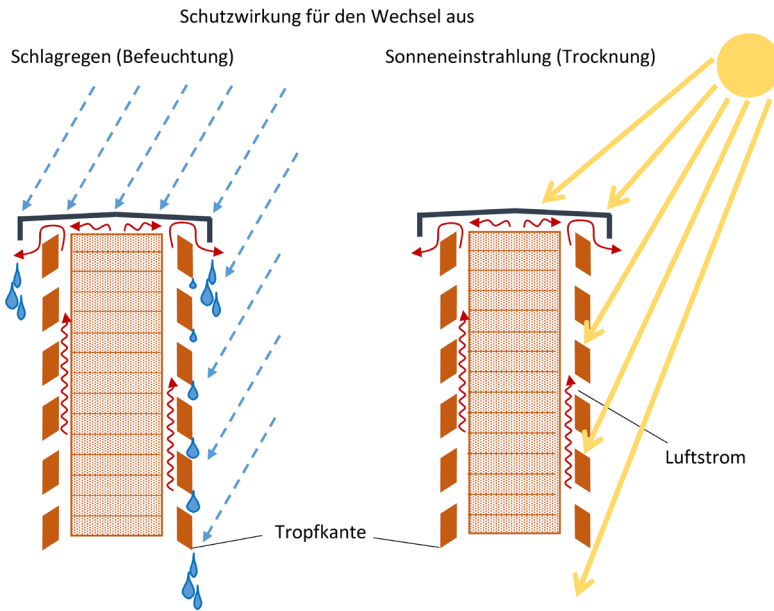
Prinzip eines in stehende Trapeze aufgelösten Flankenschutzes
